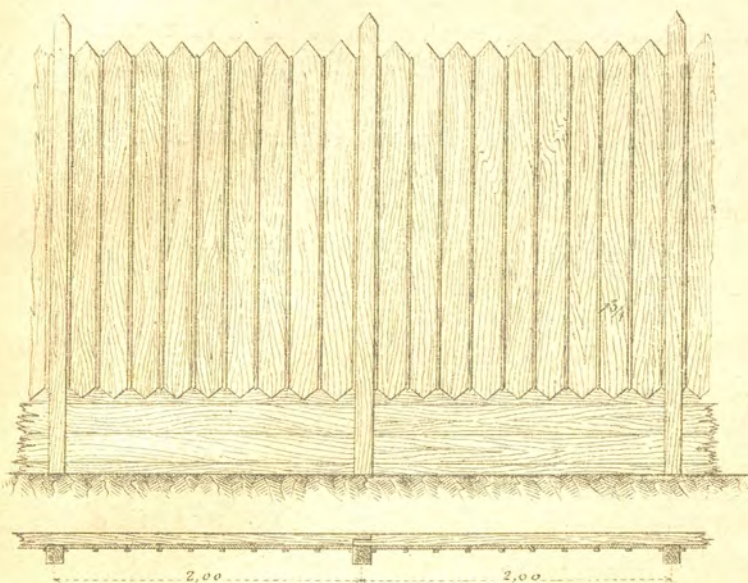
Prospetto esterno e pianta. — Scala 1 a 50.
